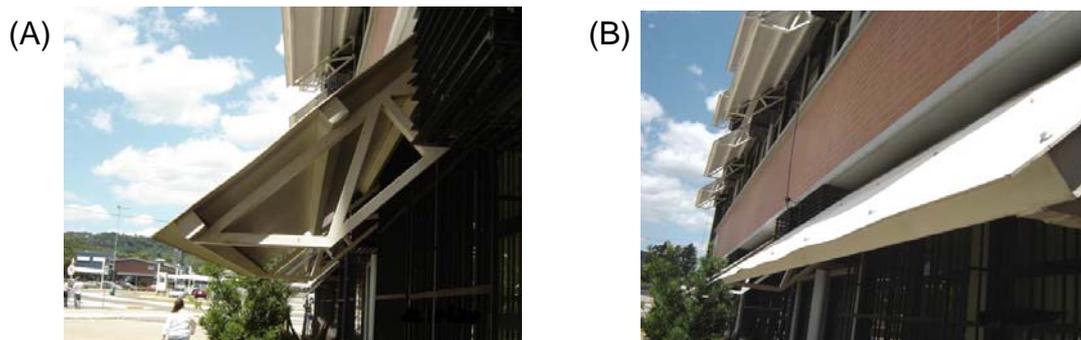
Detalhes (A) estrutura metálica (B) fixação painéis
